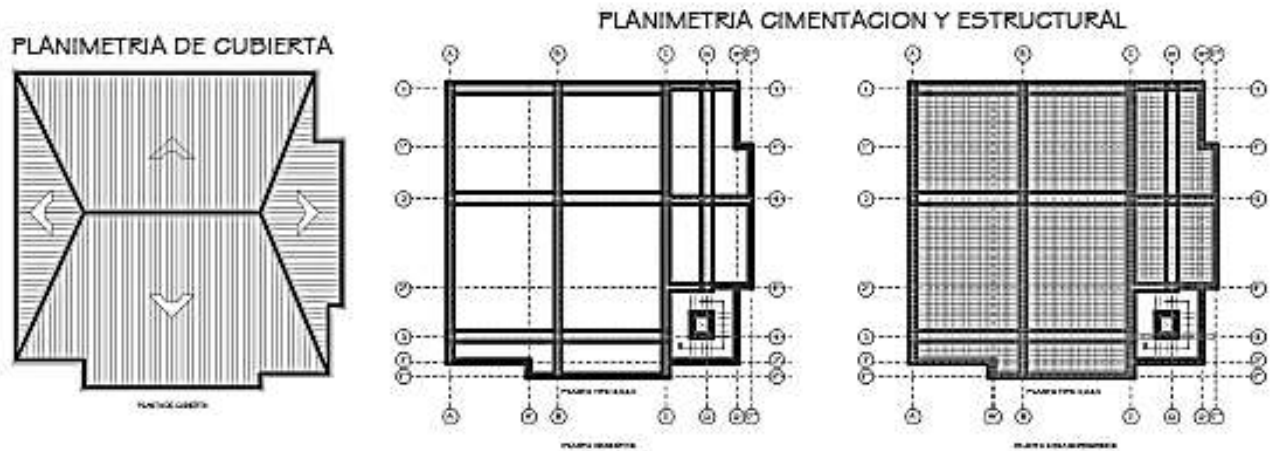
Planimetría de cimentación y estructura (Mosquera, 2020).
